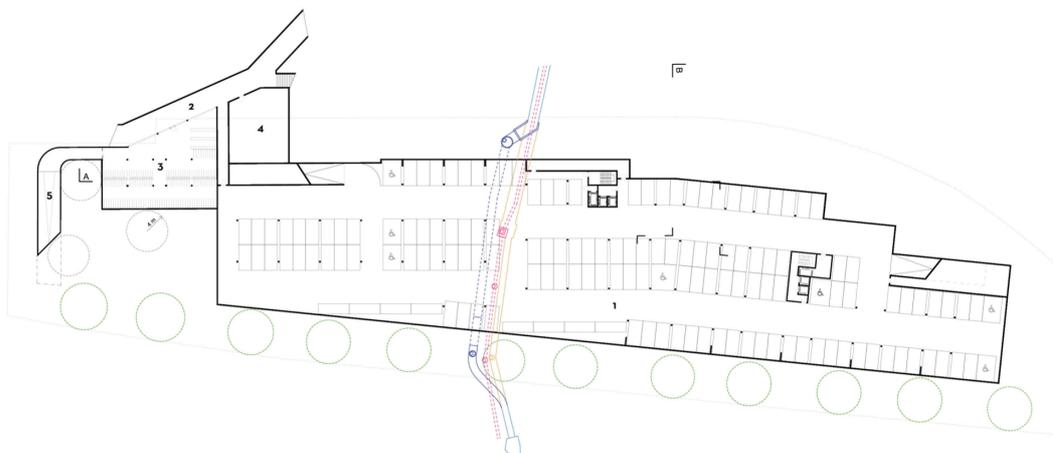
Ausschnitt Plan Untergeschoss aus Richtprojekt, Baulink AG, 2023
